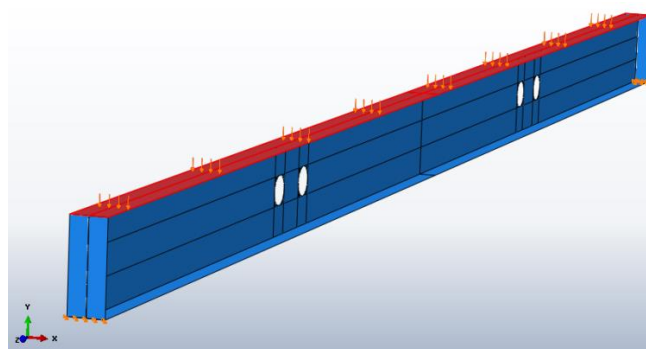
Viga biapoada com furos na alma e enrijecedores de apoio
